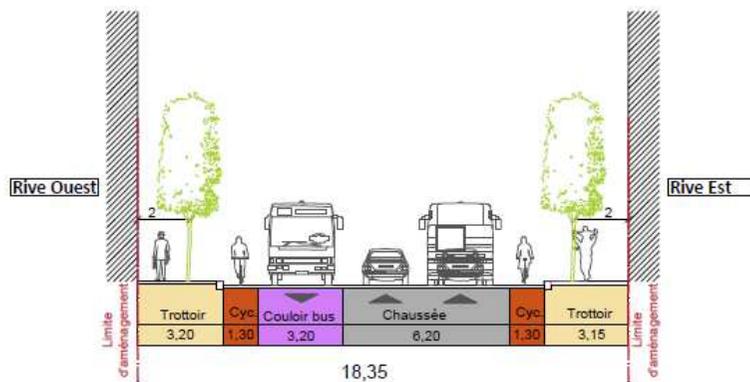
Coupe type en section courante sur le boulevard Berteaux
